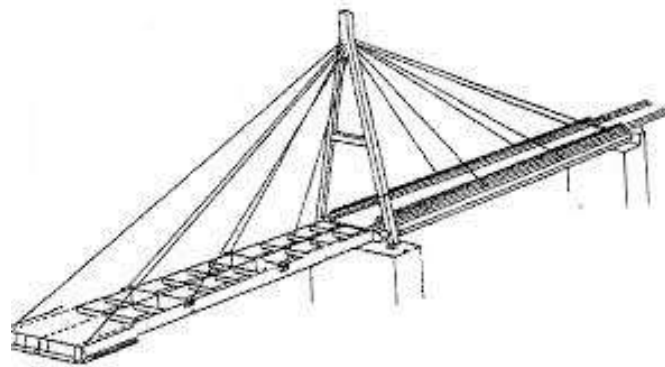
Configuración de puente atirantado con pilar central en forma de A.
